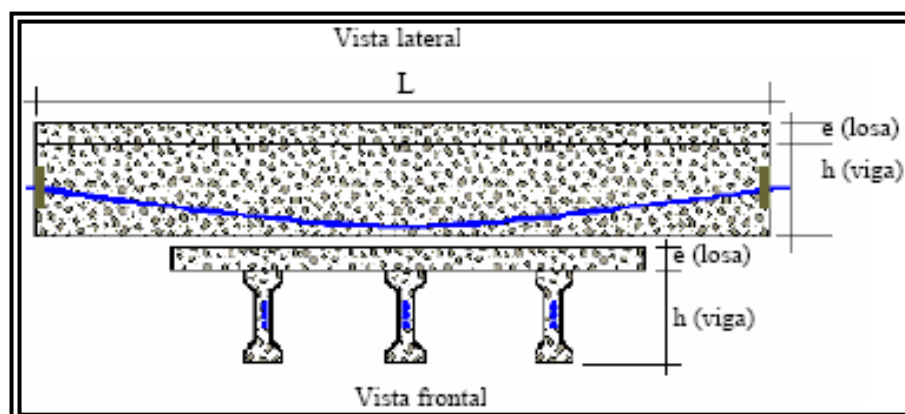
30 Puente con vigas de concreto postensado⁵⁵.
